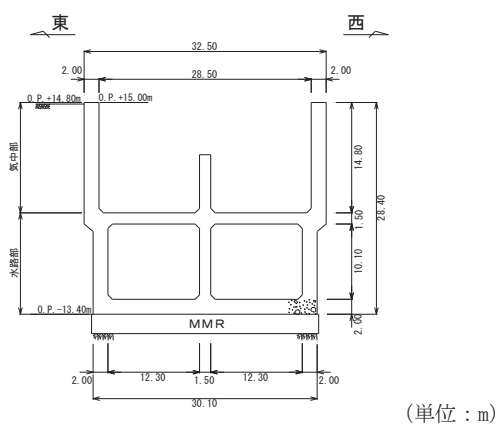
海水ポンプ室断面図 (C-C 断面, 東西)
